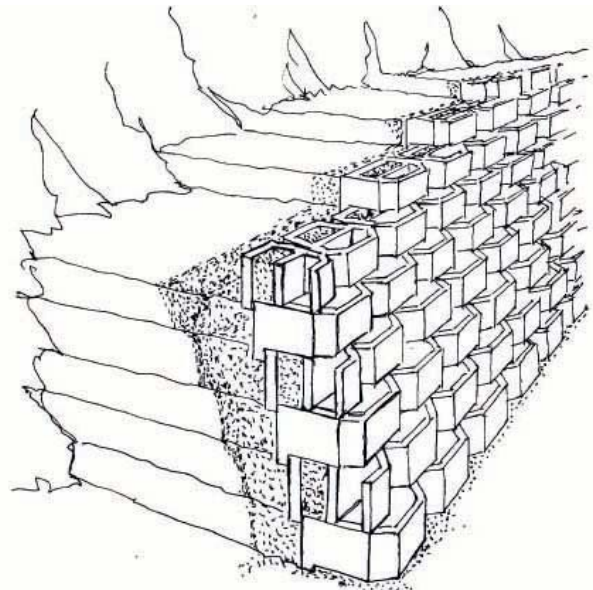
Corte de un muro con las capas de material drenante y terraplén compactado.
